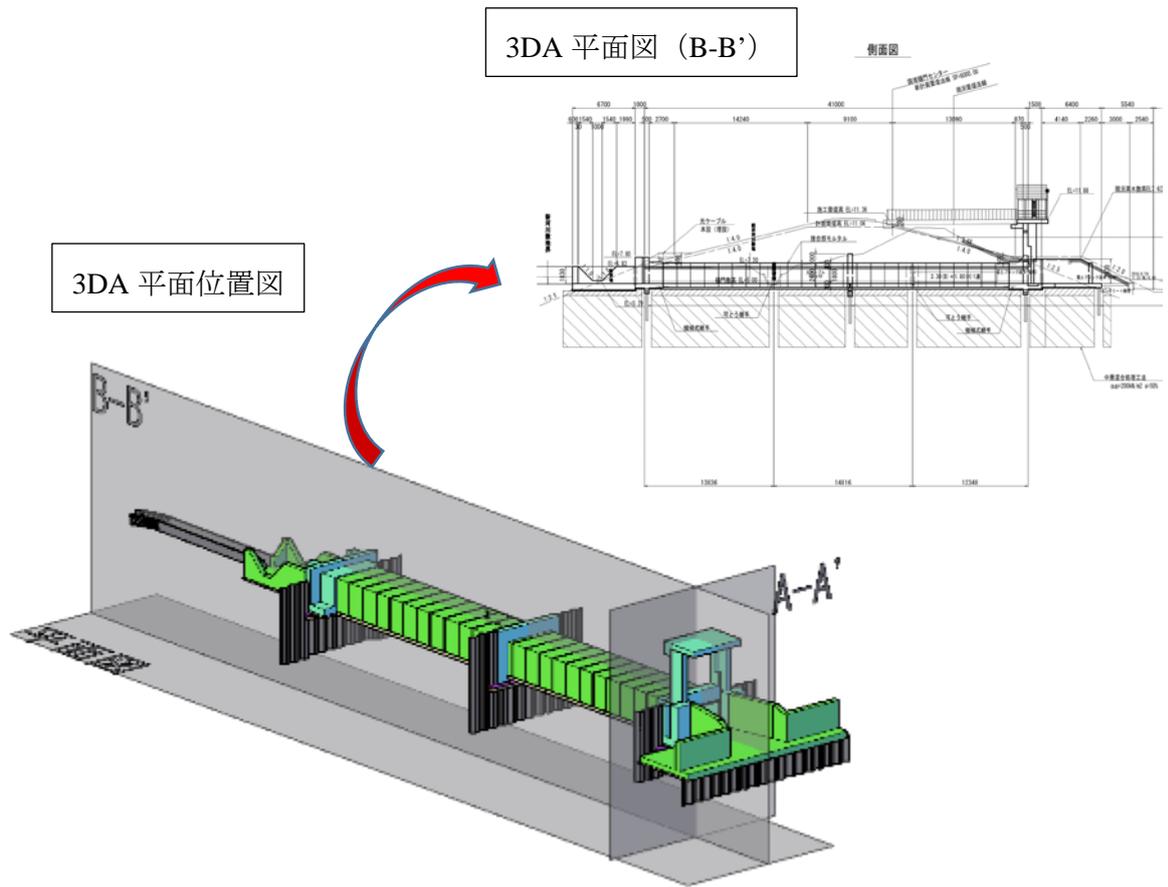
3DA 平面位置図からの 3DA 平面図の表示例
